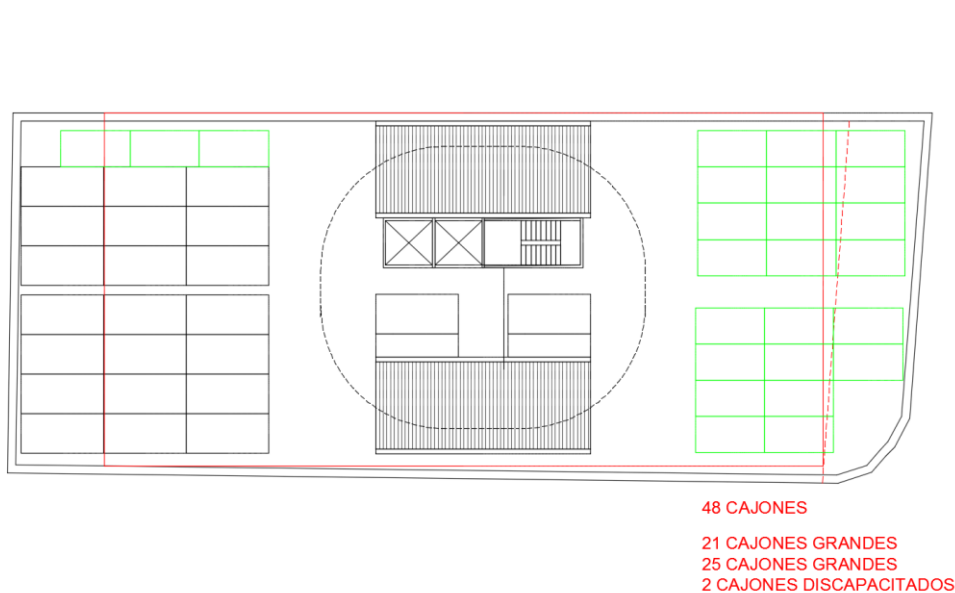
PLANTA ESQUEMATICA SOTANOS
